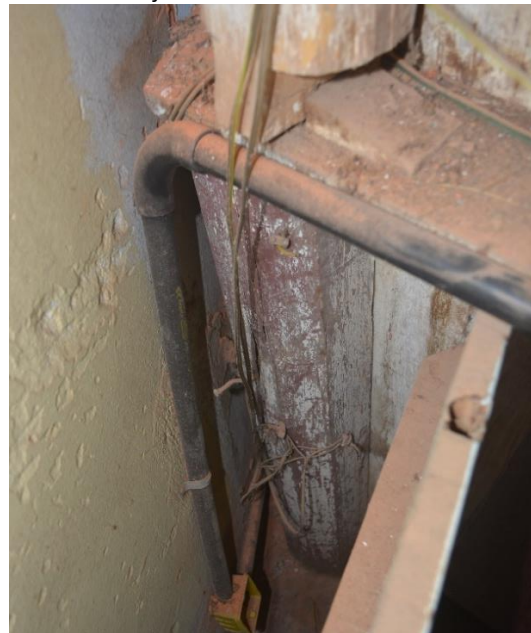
Abertura de galerias para análise do estado de conservação da estrutura do retábulo
